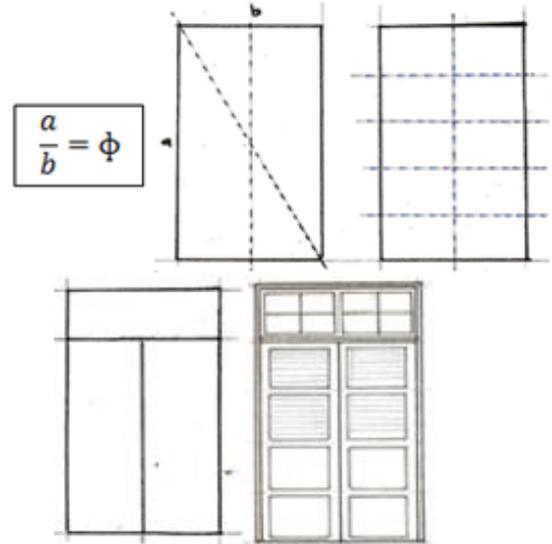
Pintu pada tampak barat bangunan Balai Kirti
